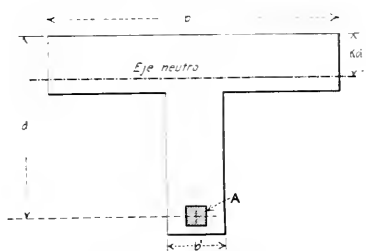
SECCIÓN TRANSVERSAL DE UNA VIGA T
